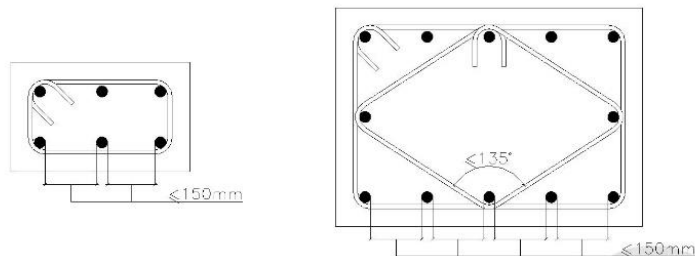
Separación máxima de barras sin apoyo lateral.
